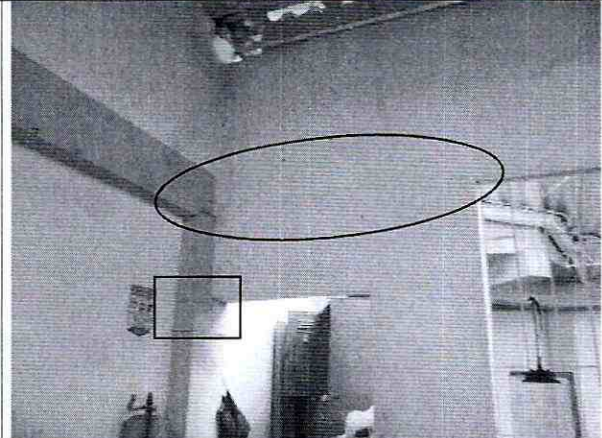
Fisura en muro divisorio y elemento de revestimiento metálico presente en algunas columnas.
